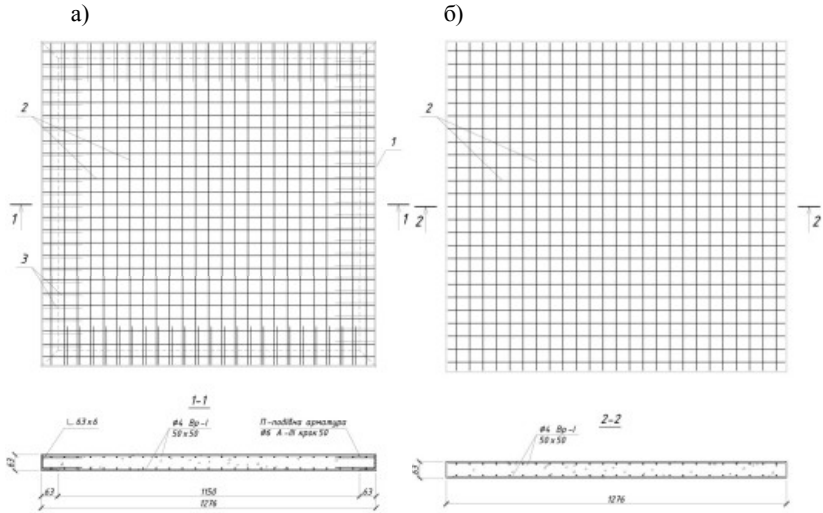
Конструкція дослідних зразків: а) сталезалізобетонна плита ПВ 63-1; б) залізобетонна плита ПВ 63-1-1 – куттик рівнополичний 63×5; 2 – сітка арматурна (Br-I Φ 4мм, крок 50×50 мЗ – анкери у вигляді II-подібної арматури Φ 6мм, крок 50мм
